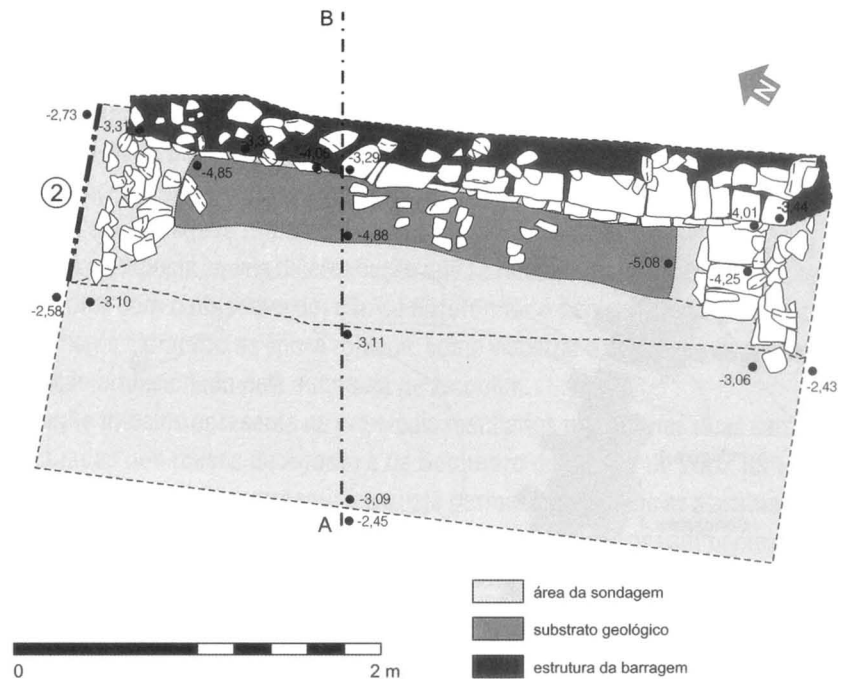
Barragem do Álamo. Planta da sondagem 1.
